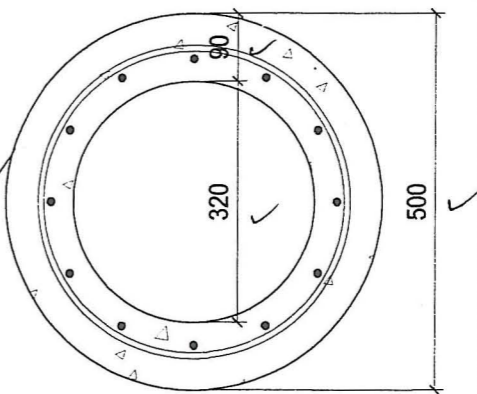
DETAIL TIANG PANCANG ( SPUN PILE )
